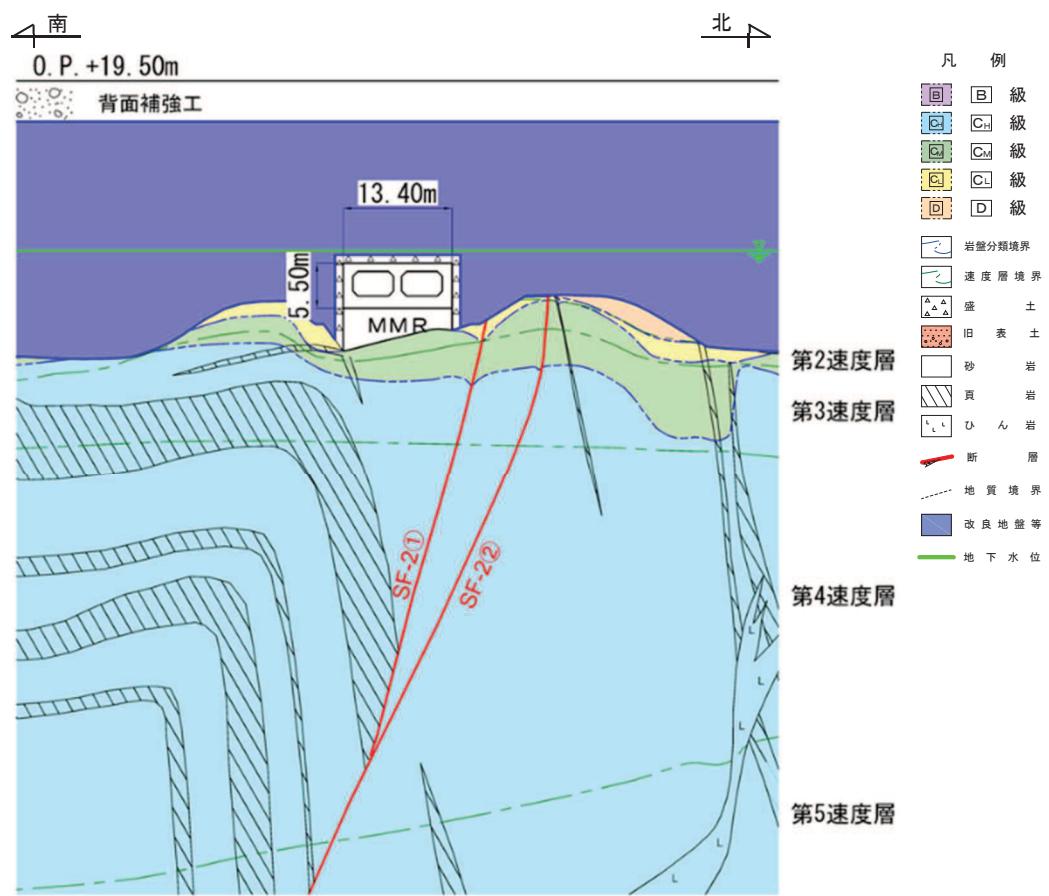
(4) 取水路（標準部） 地震時荷重算出断面図（断面⑤：直線部及び曲線部）
